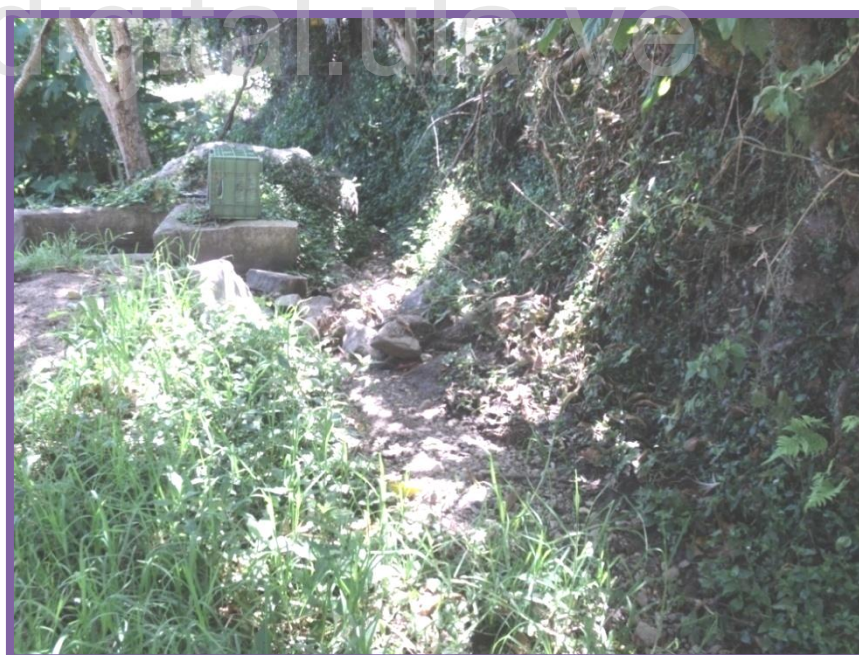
Ubicación de tanquilla en el canal de riego.
